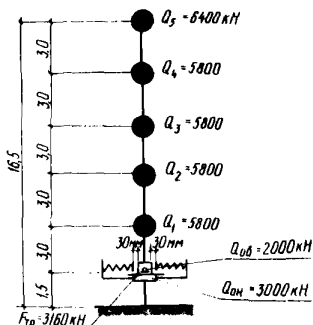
Расчетная схема 5-этажного крупнопанельного дома с сейсмоизолирующим скользящим поясом
